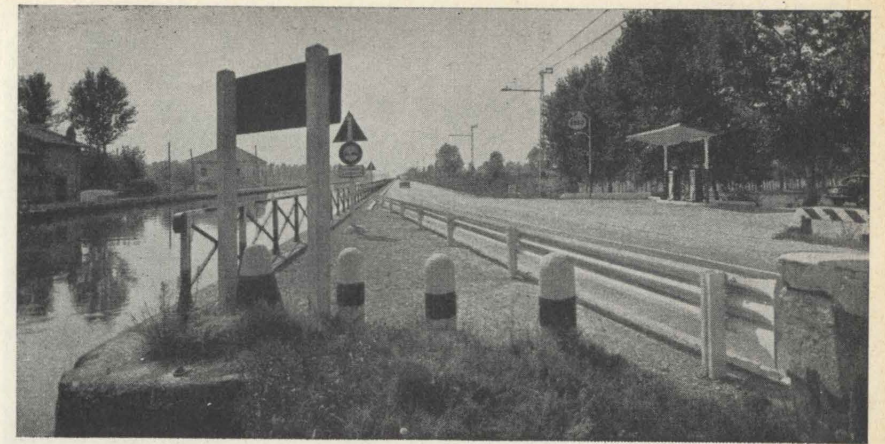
Restringimento della carreggiata, protetto dalla barriera.
